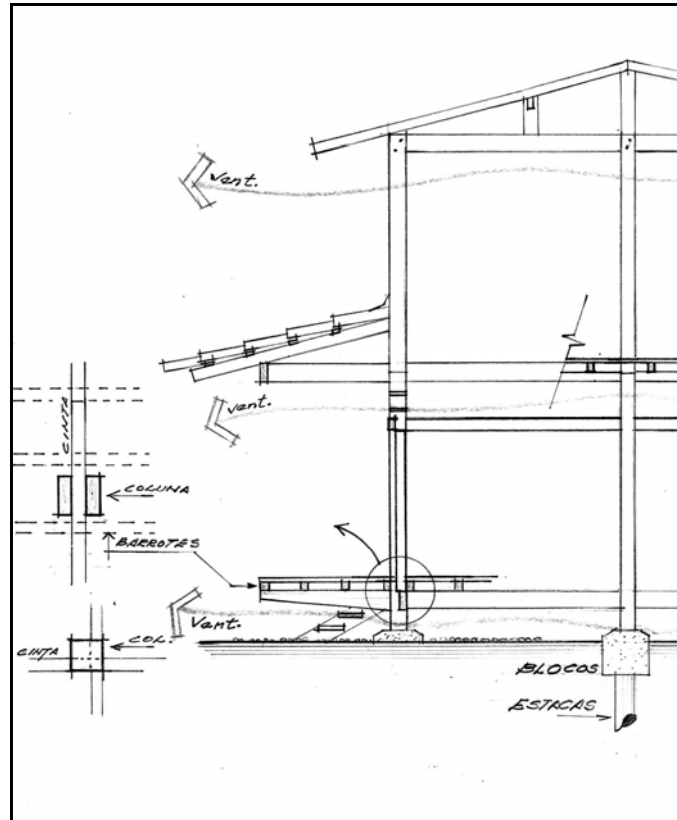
Corte demonstrativo com detalhes estruturais (parcial nº 2)
